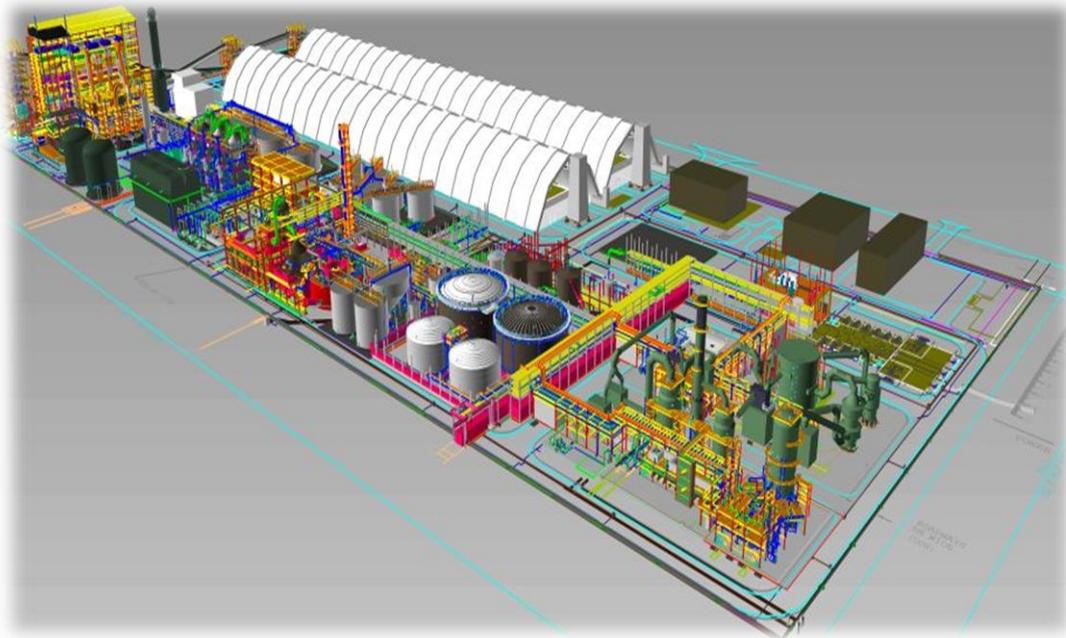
PLAN DU PROJET ODI – P1 SUR AUTODESK NAVISWORKS 2014
